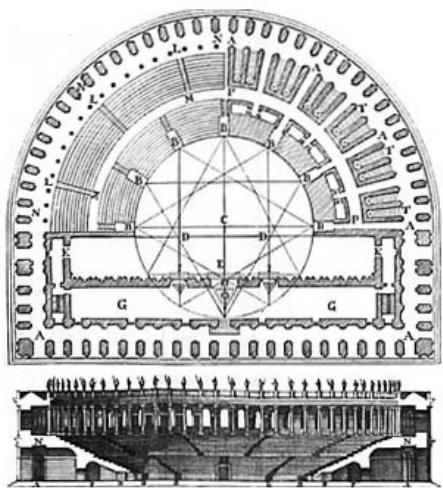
Planta i secció d'un teatre segons Vitruvi
